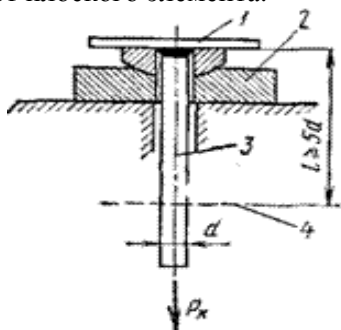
Схема испытания на отрыв изделия арматурных с тавровыми соединениями:
